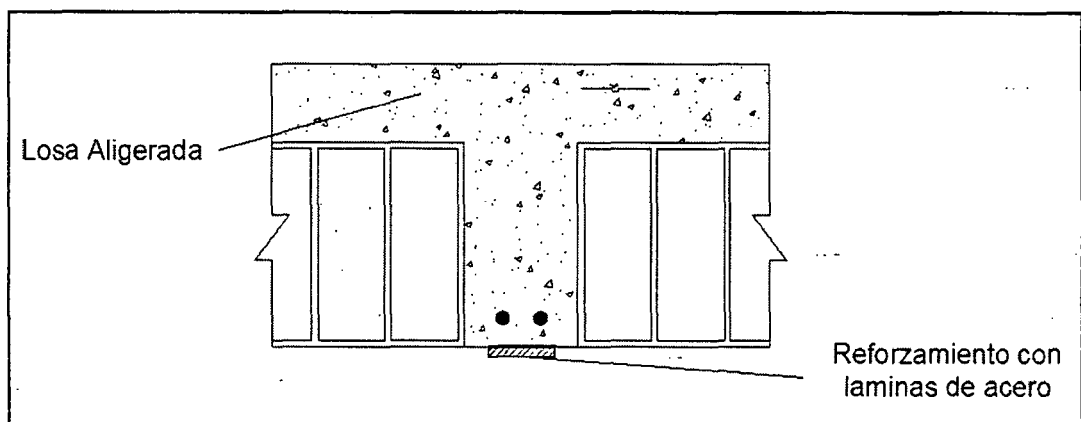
Refuerzo de la viga mediante laminas de acero.
